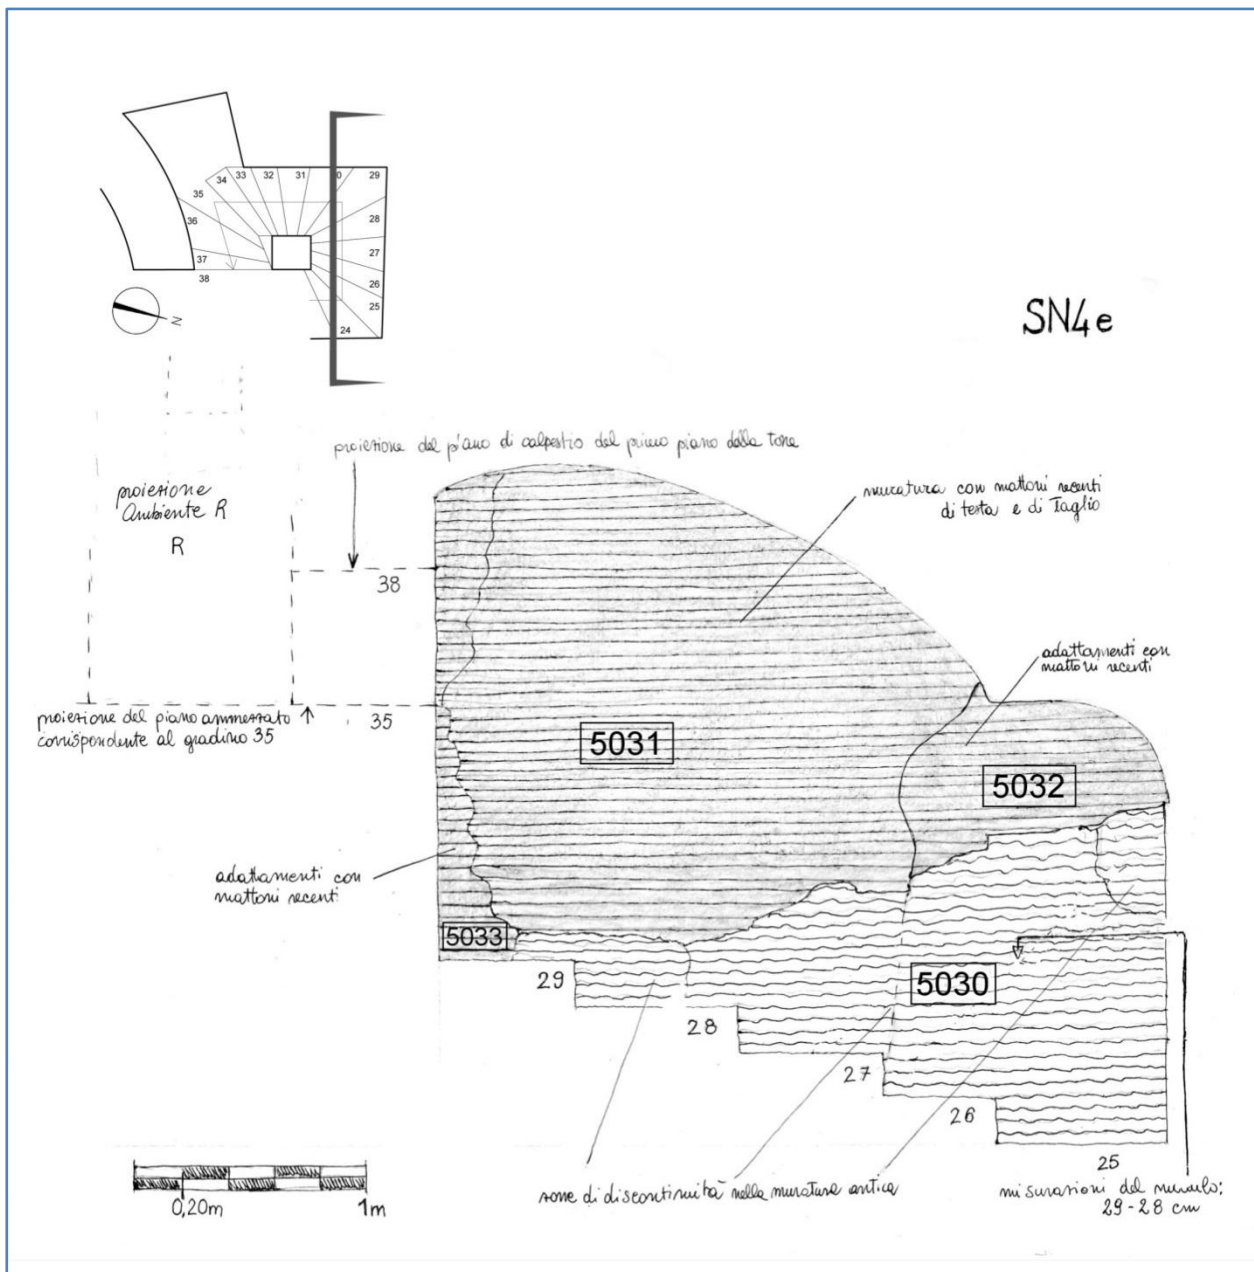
Prospetto SN4e. Disegno D'Ippolito.
